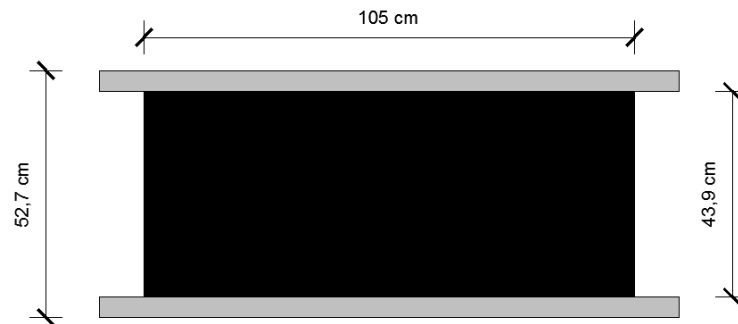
Dimensiones del aislador para el edificio de 15 pisos
